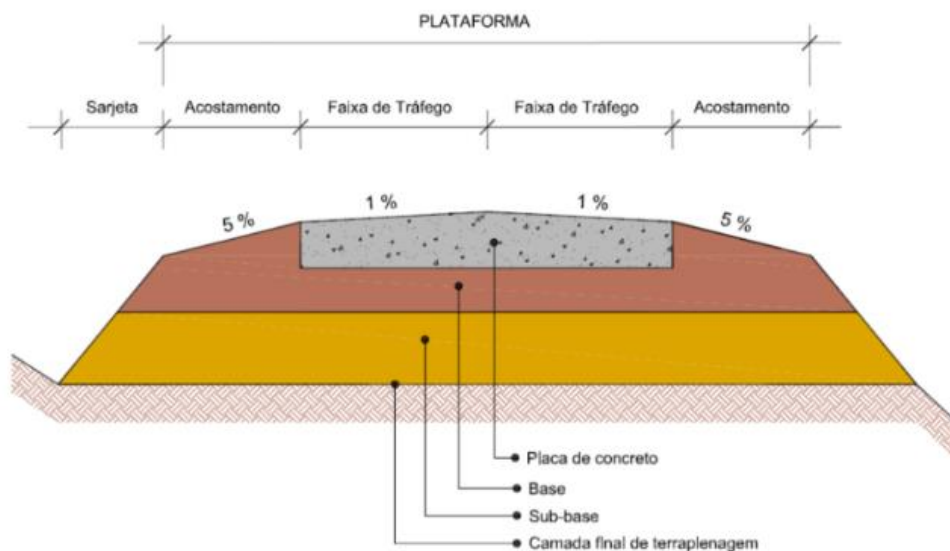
SECÇÃO TRANSVERSAL TÍPICA DE PAVIMENTO RÍGIDO
